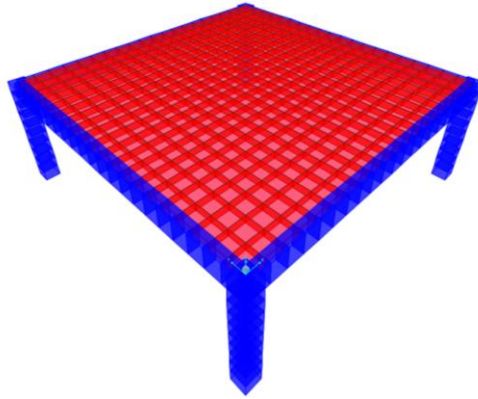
Modelo de losa de concreto reforzado con $a_2=8m$
